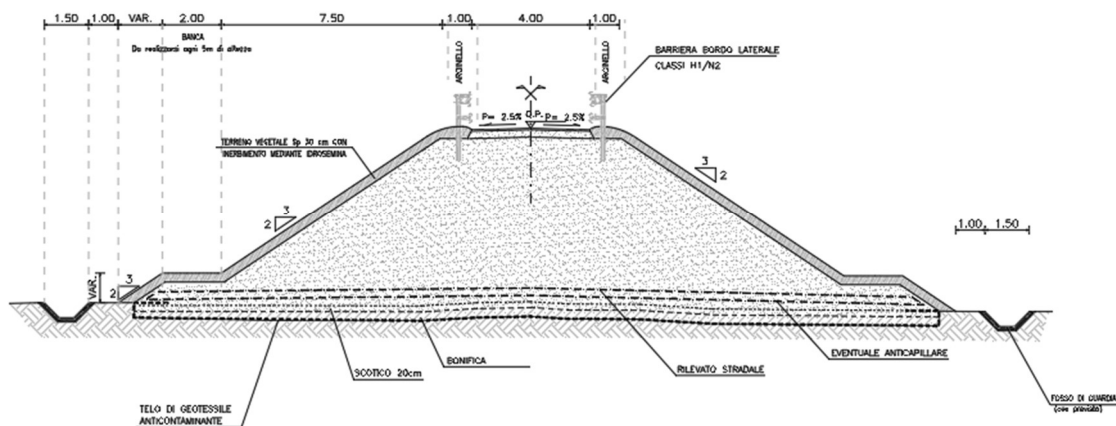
sezione tipo strade a destinazione particolare in rilevato
